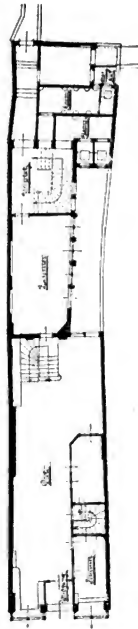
Grundriß des Hauses Langenstraße Nr. 12, „Essighaus“.
